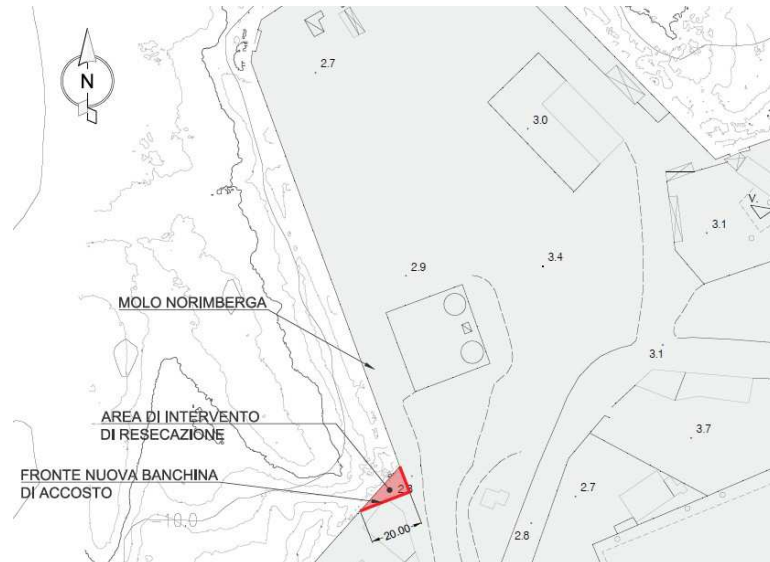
Planimetria dell'intervento sulla banchina da consolidare.
